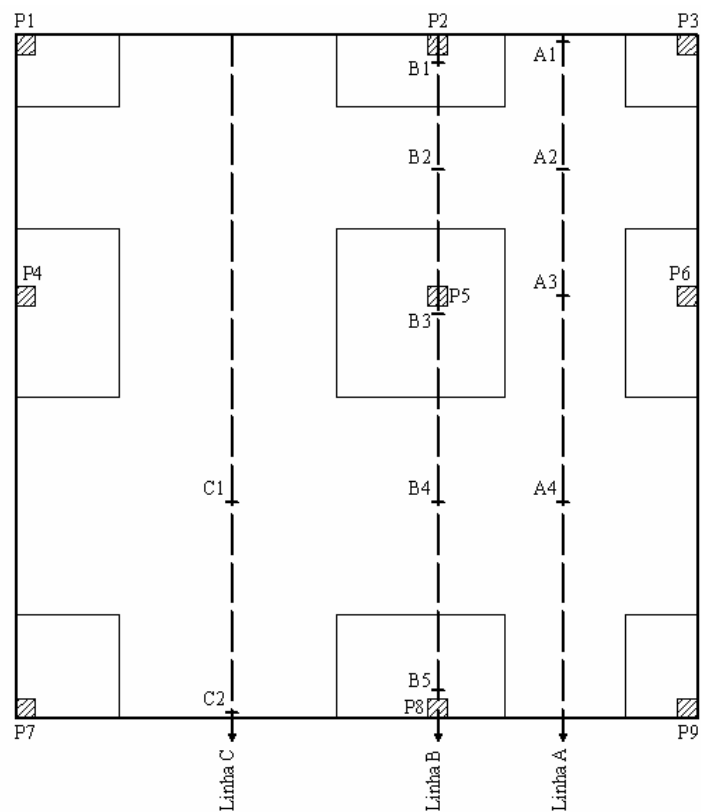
Linhas e pontos de leituras na laje em planta.
